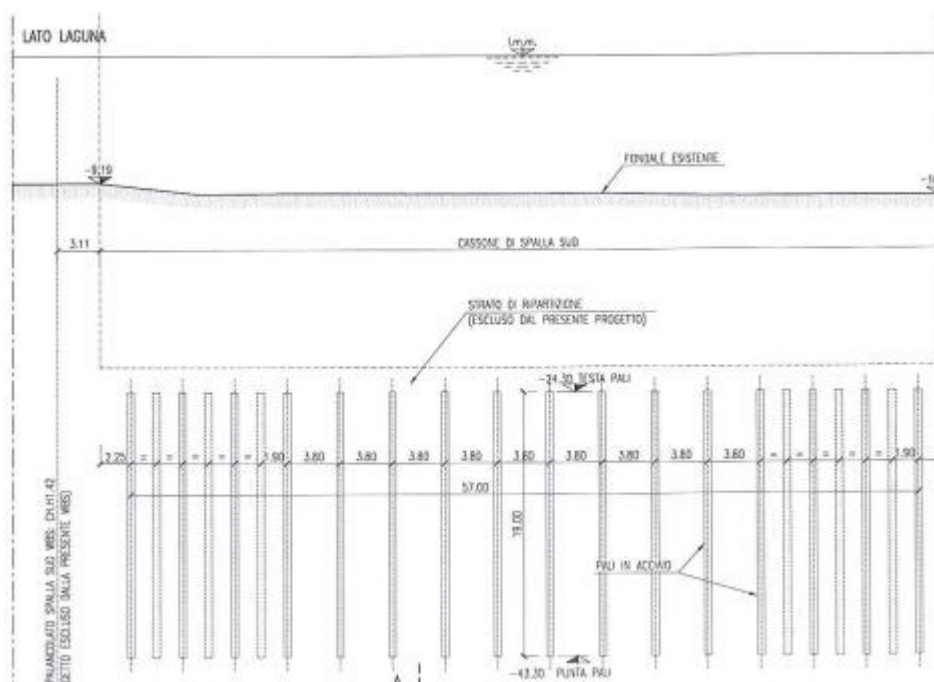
Sezione tipo cassone di spalla Sud; estratto dagli elaborati grafici AS BUILT.
